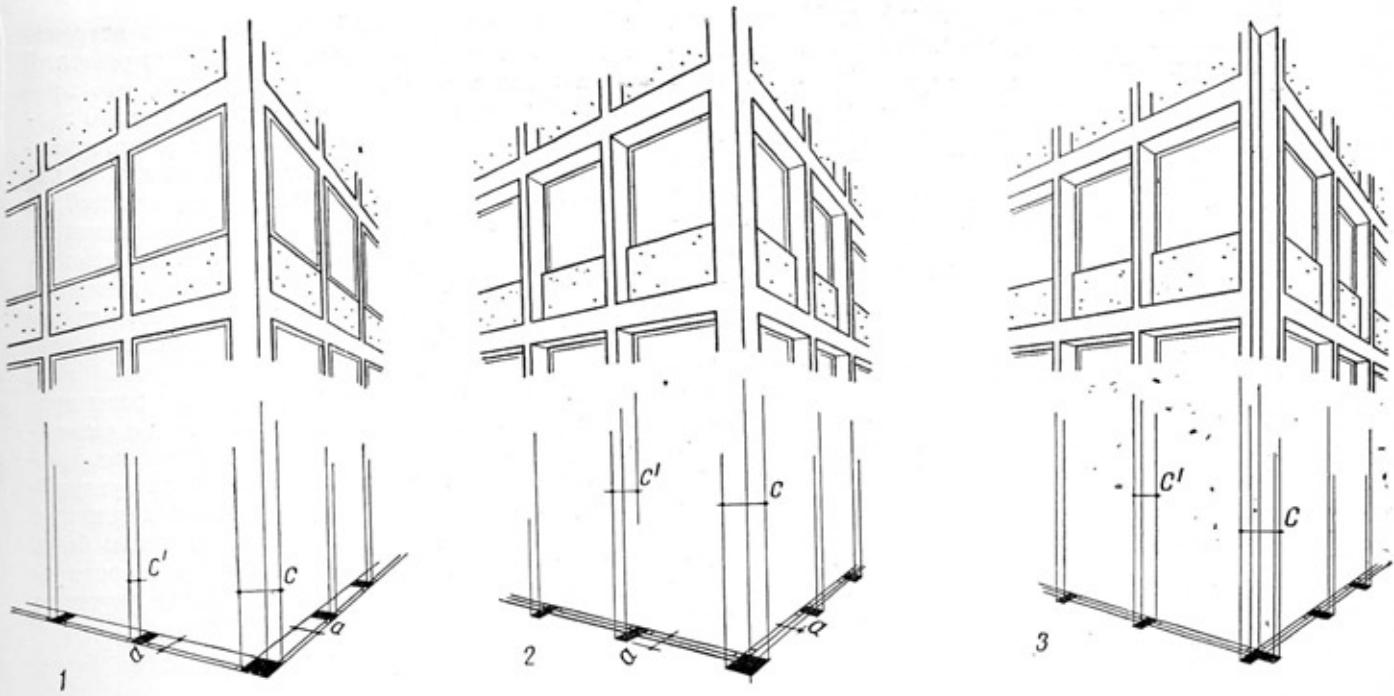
Схема распределения нагрузок в каркасе с несущей угловой колонной и узким шагом колонн по всем фасадам. Угловая колонна нагружена меньше всех других колонн
